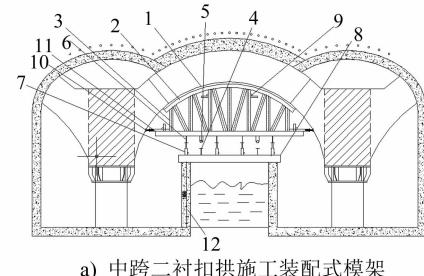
地铁暗挖车站二衬扣拱施工工序剖面示意图
